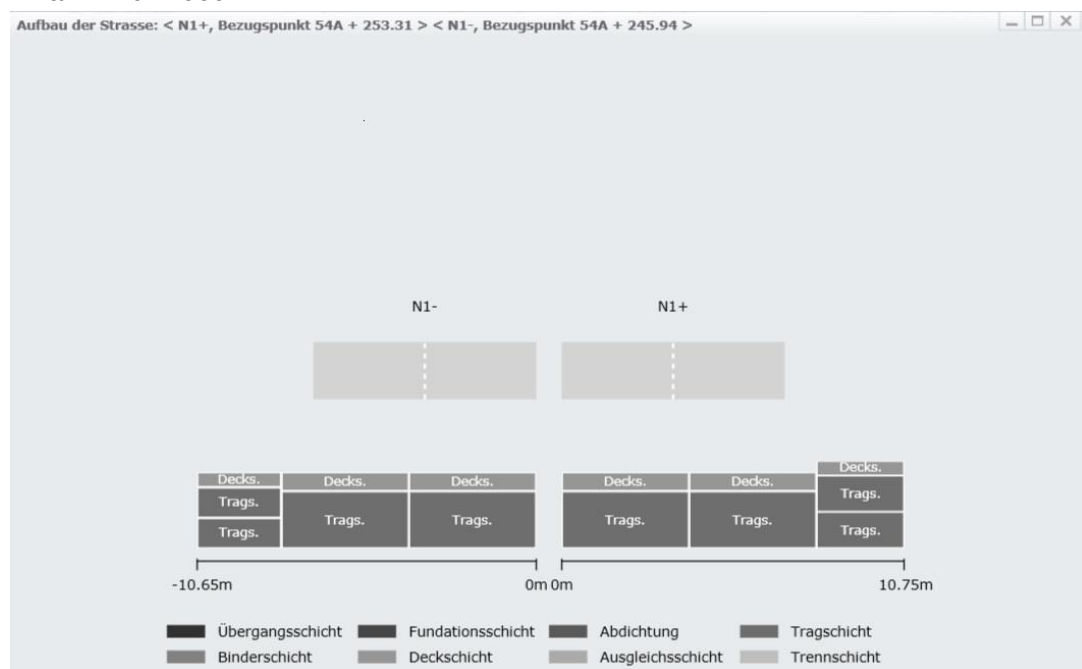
Strassenquerschnitt bei Rebacker 24.12.2014
